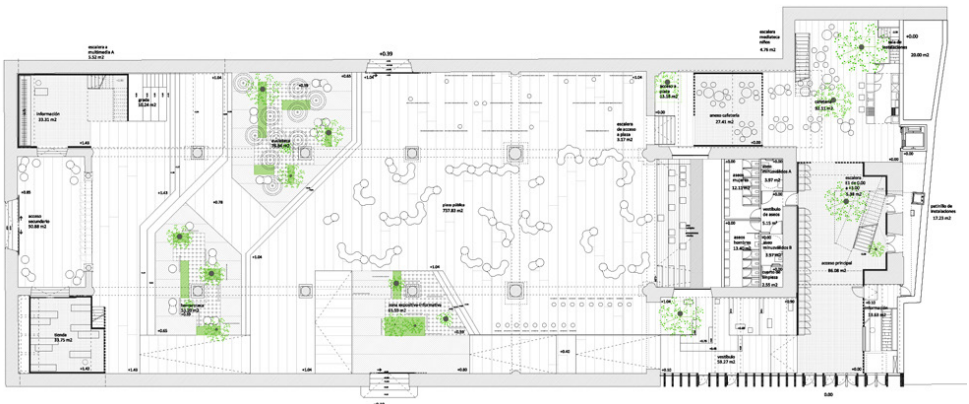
Planta baja del proyecto Mediateca San Agustín (Autor: SIC Arquitectura, 2005)
